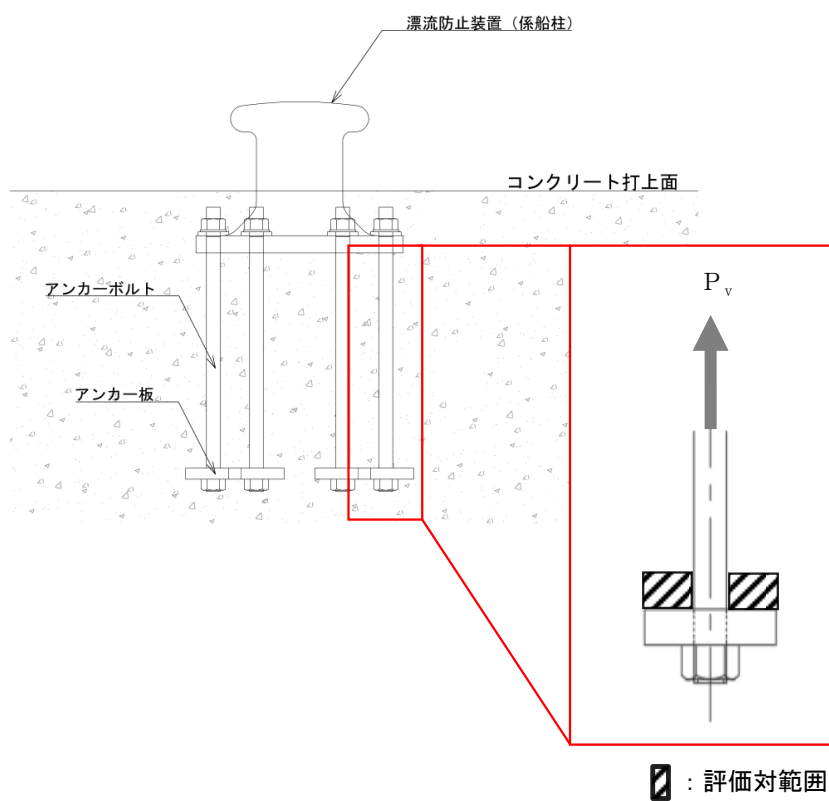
コンクリート（アンカー板上面）のモデル図
